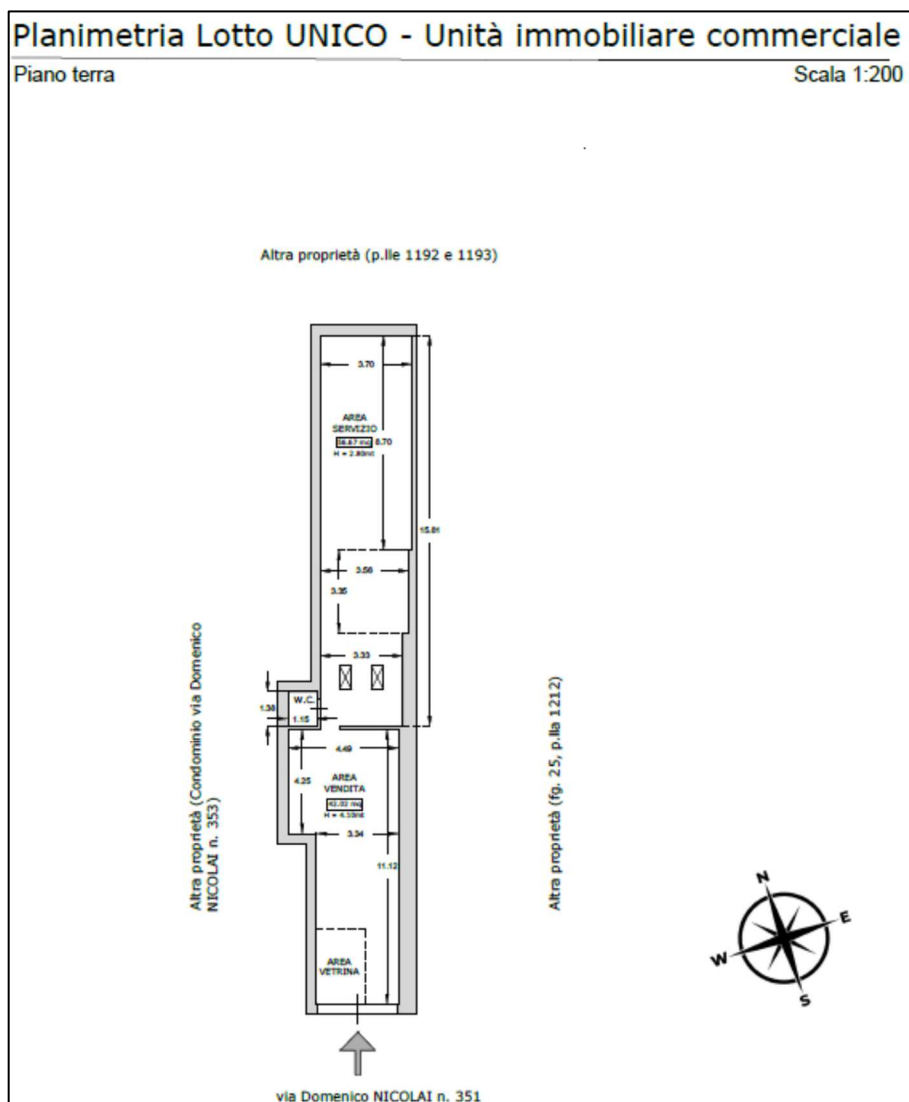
Stralcio di planimetria redatta dal C.T.U.
